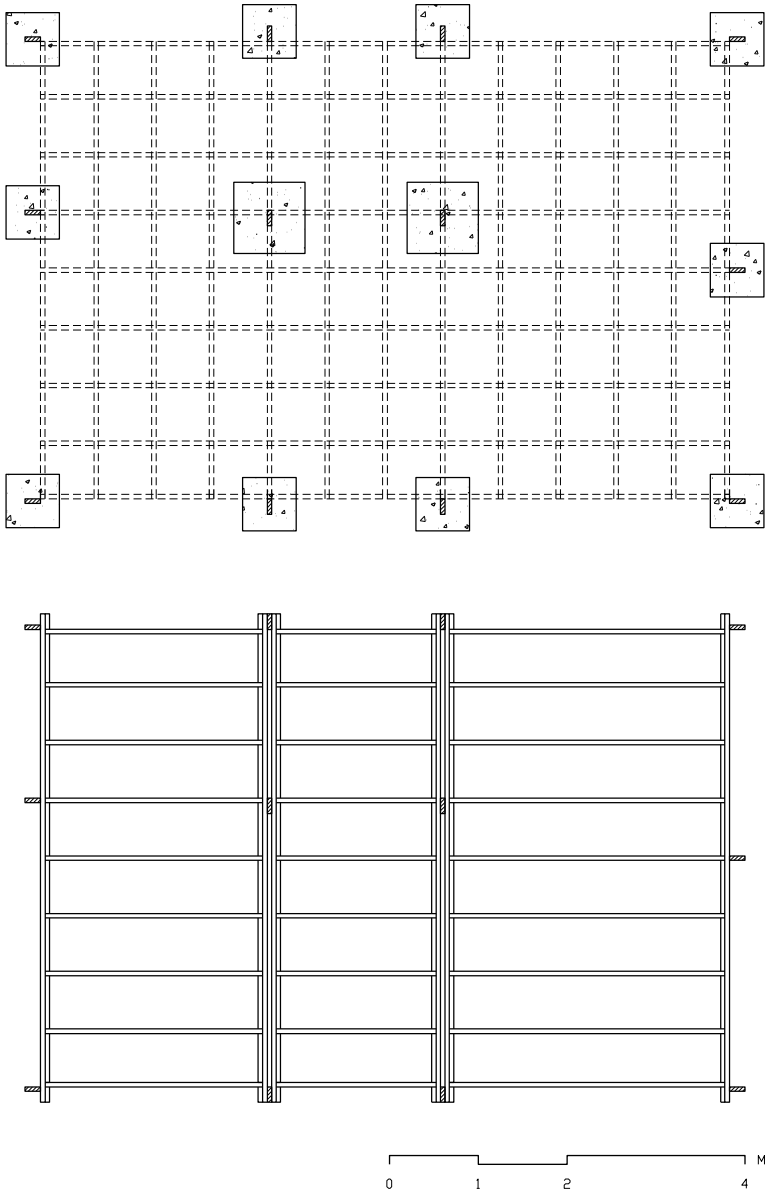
pianta delle fondazioni e dei moduli (in alto), e pianta strutturale del piano terra di un edificio per Lewisham.
